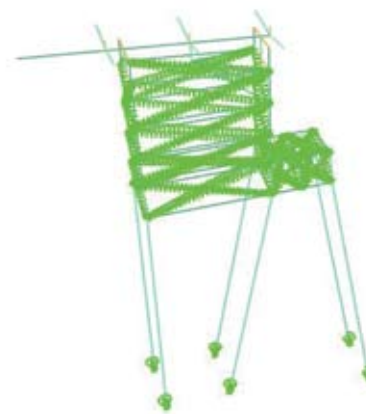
Модель северного устоя для расчета методом конечных элементов с применением методики расчета железобетонных конструкций по аналогии с шарнирными фермами
